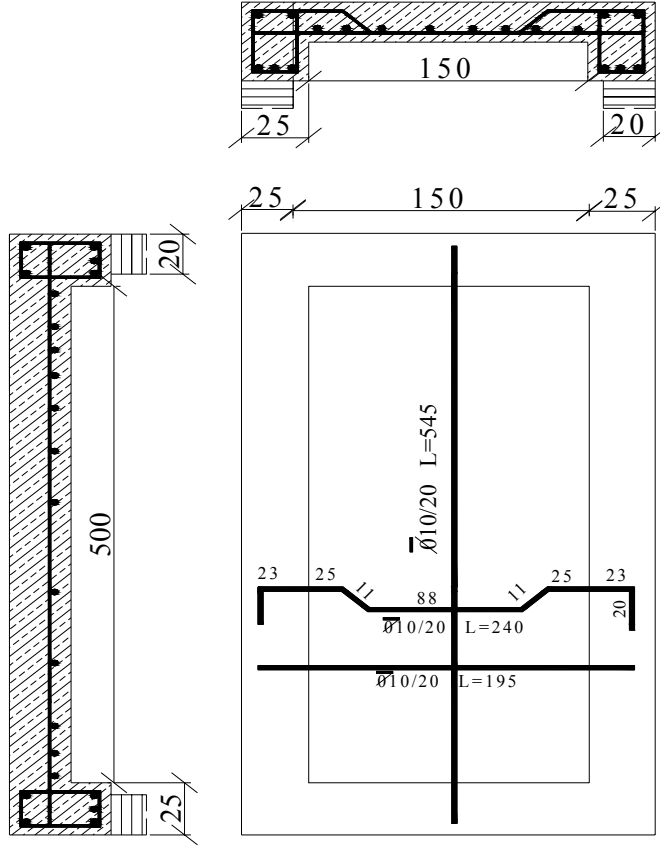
Örnek döşeme demir donatı planı ölçek 1/50
